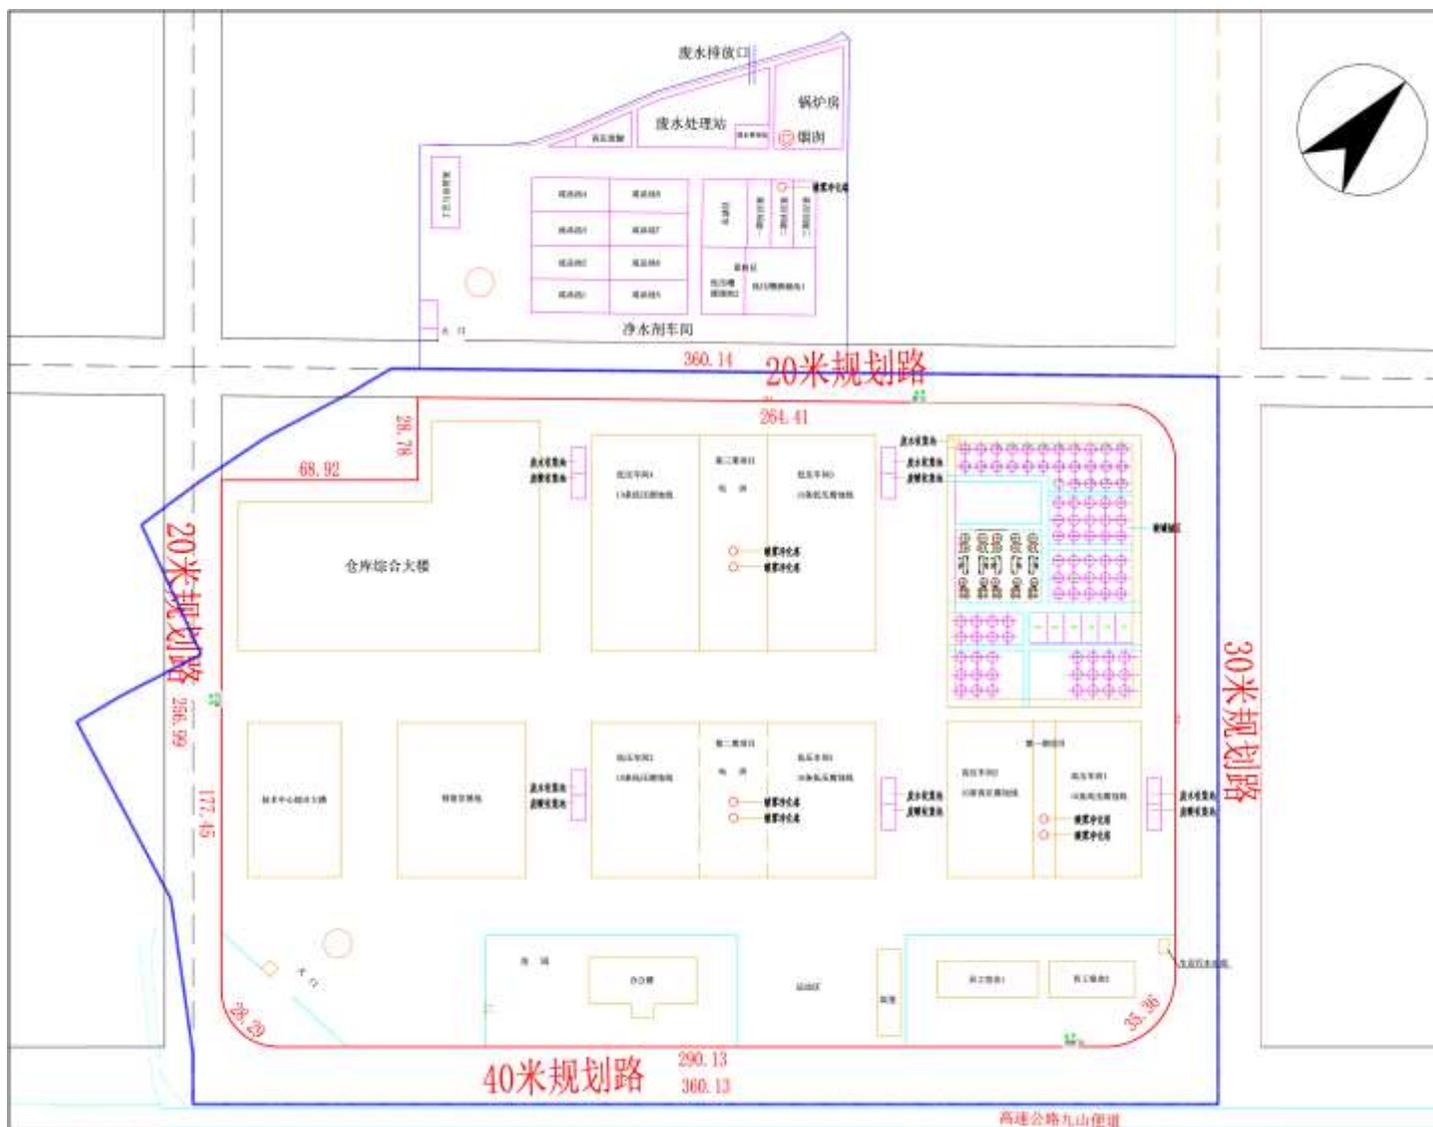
高要市华锋电子铝箔有限公司环评阶段平面布置图
